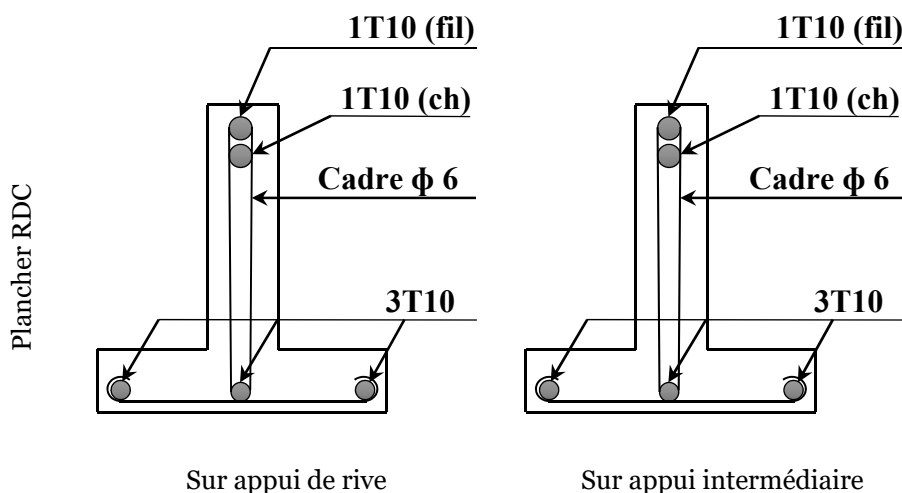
Dessin de ferrailage des poutrelles des étages RDC
